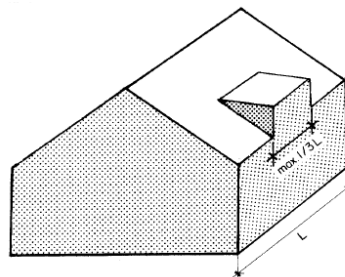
schematische Darstellung Dachaufbauten gemäss altPBG (1/3 der Fassadenlänge)
